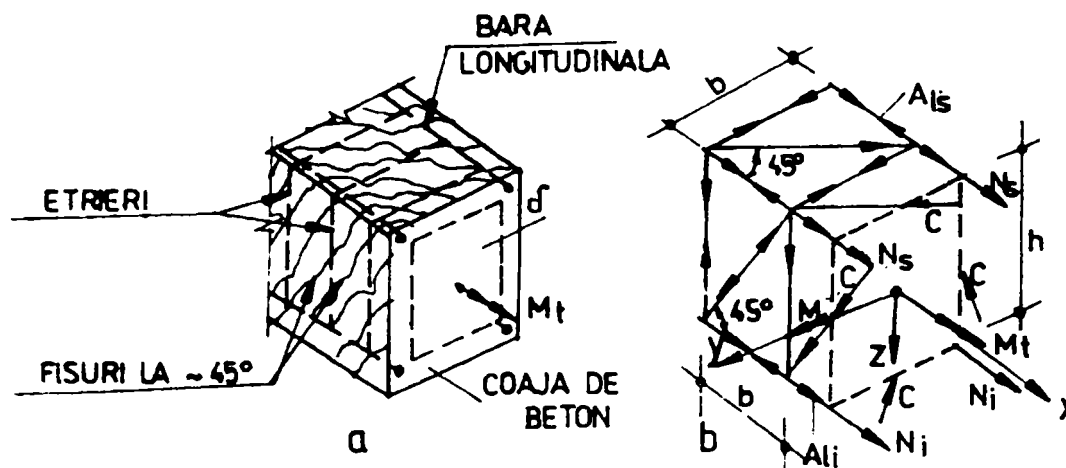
Modelul de rupere al elementului din beton armat sollicitat la torsiune
